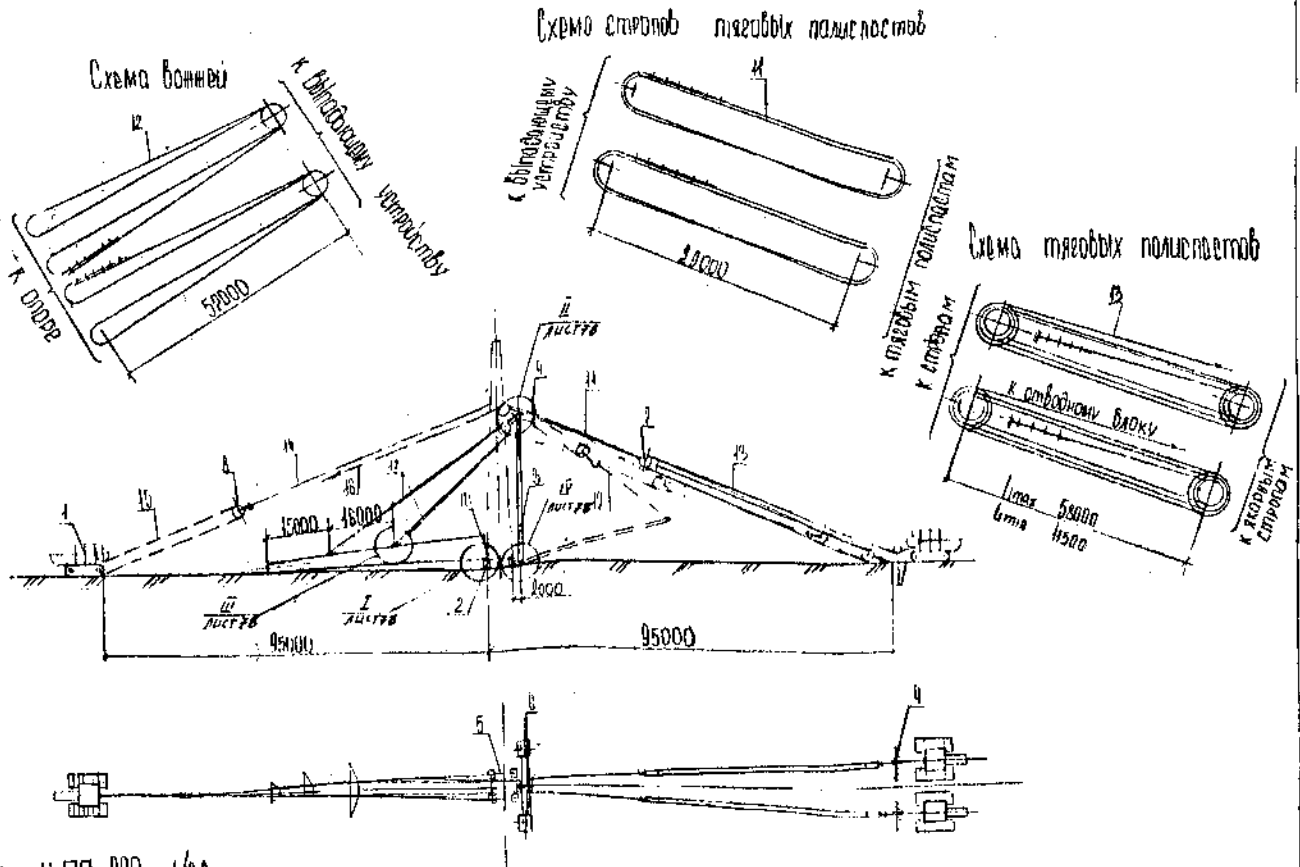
Схема подъема опоры ГП 220 - 1/38
